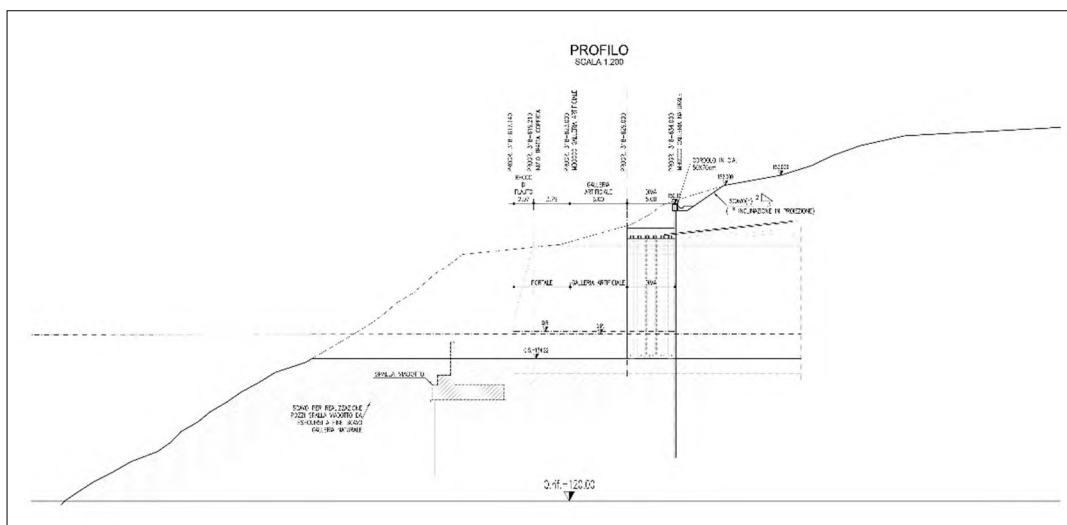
Profilo longitudinale imbocco Nord Bruschetto (IB02N, Stralcio da elab. APE2101)
